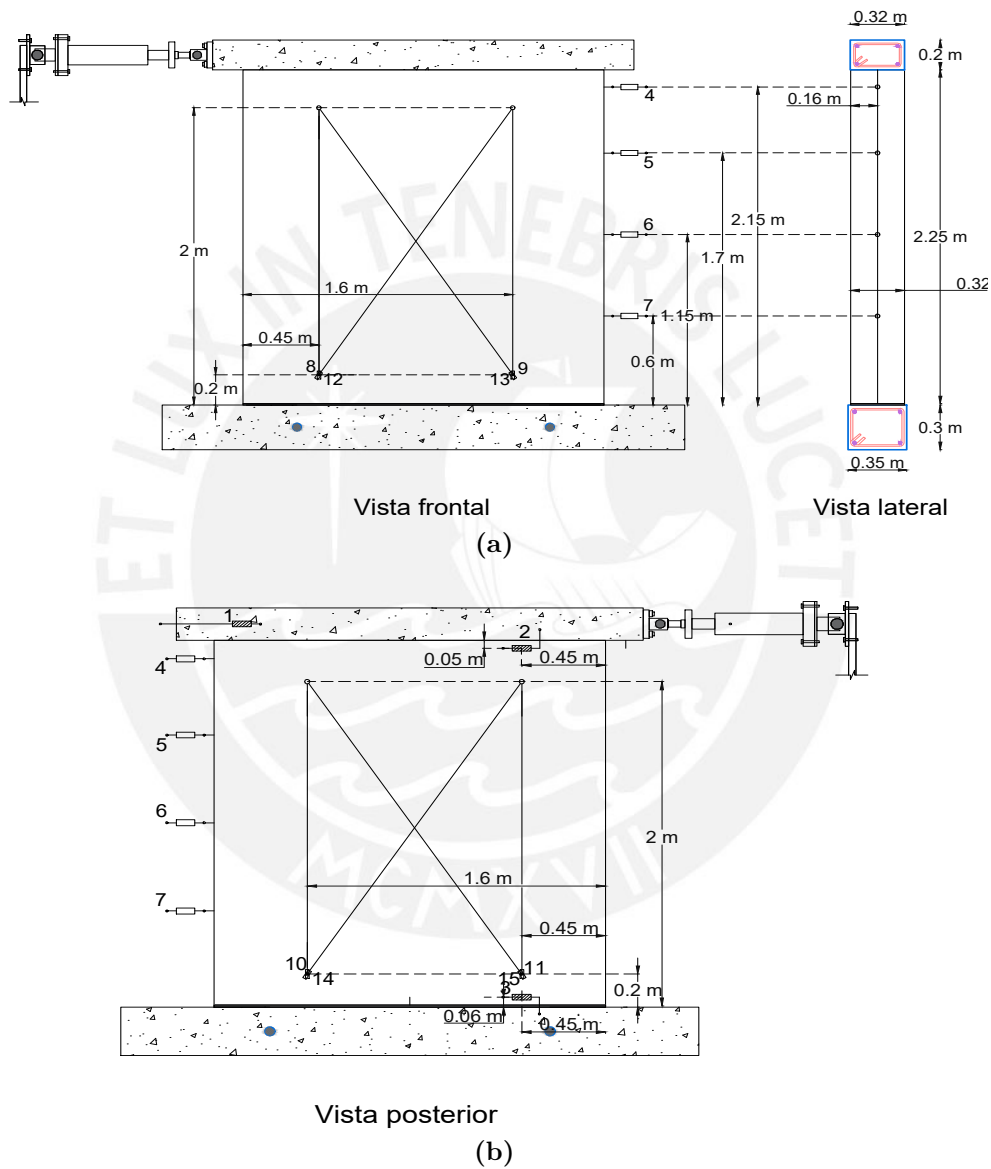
Configuración de la instrumentación del ensayo de corte cíclico en muros sin refuerzo: (a) vista frontal y (b) vista posterior.
